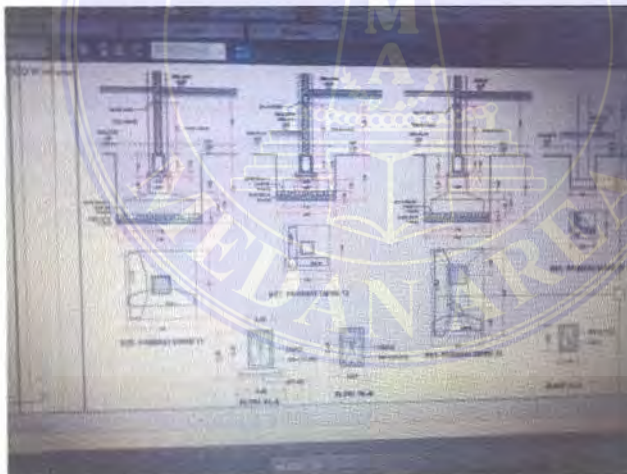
Pengerjaan Denah Pondasi Masjid
